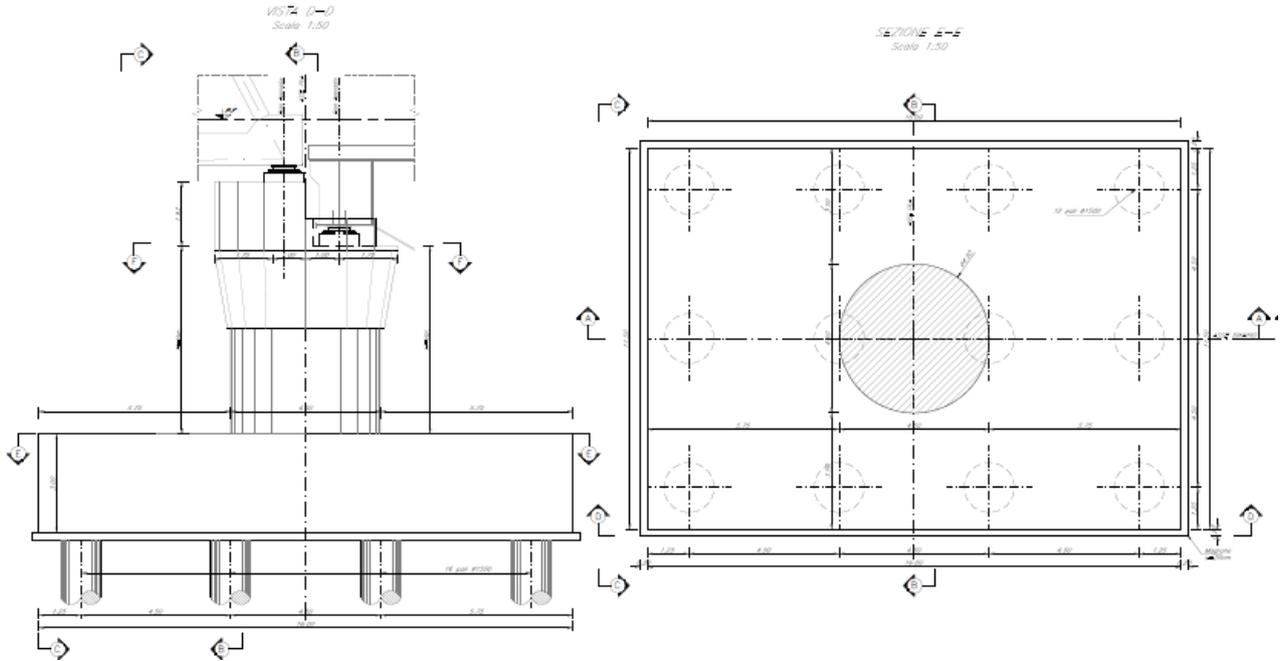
Prospetto e sezione pila campata L=69.70 m /45.00 m
